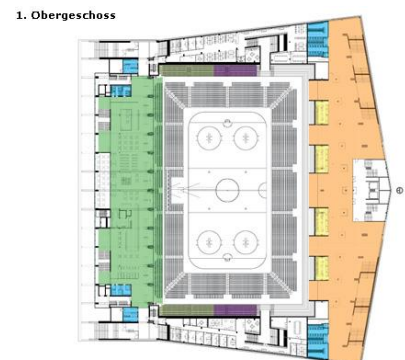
PostFinance Arena в Берне. Видовой кадр, план 1-го этажа
